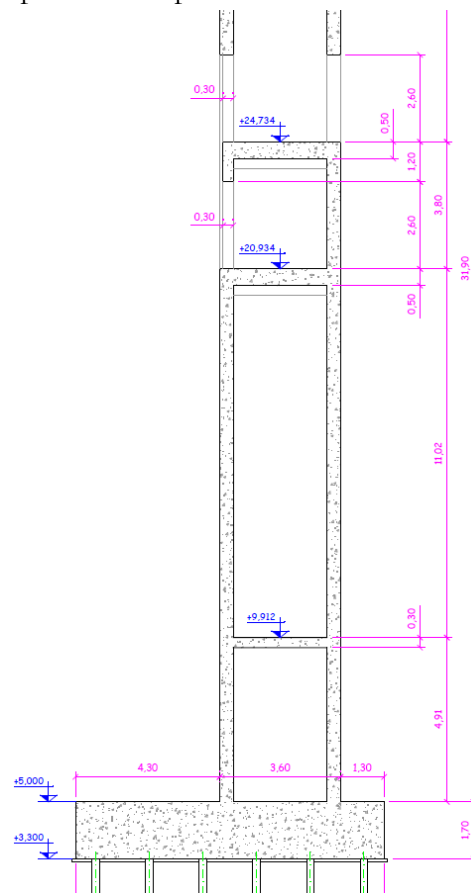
Sección de la torre y su cimentación según planos de proyecto.
